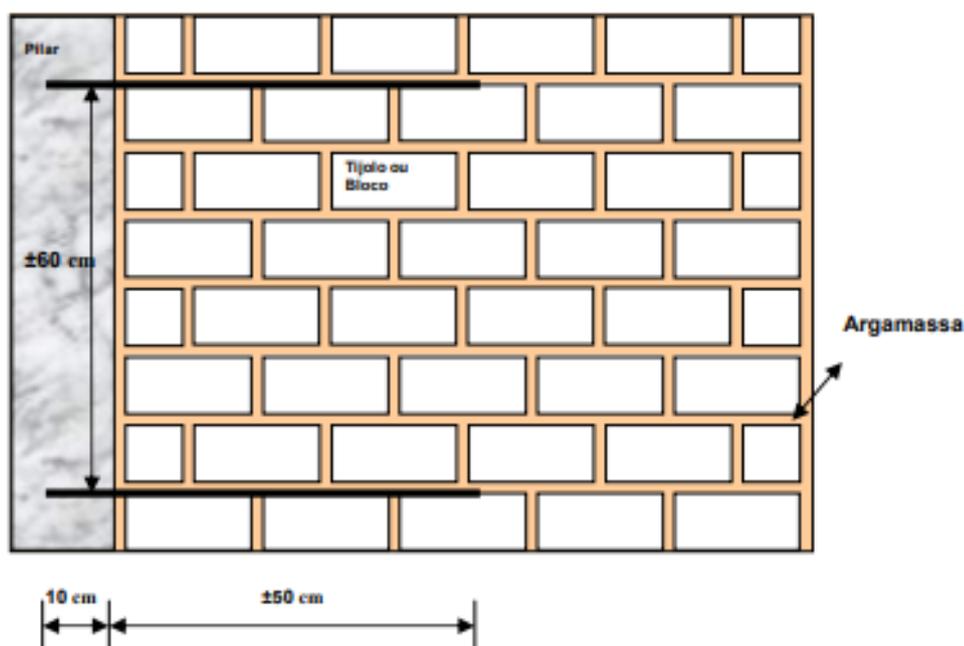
Esquema da ligação alvenaria com pilar de concreto armado. Fonte: ABNT - NBR 8545, 1984.
